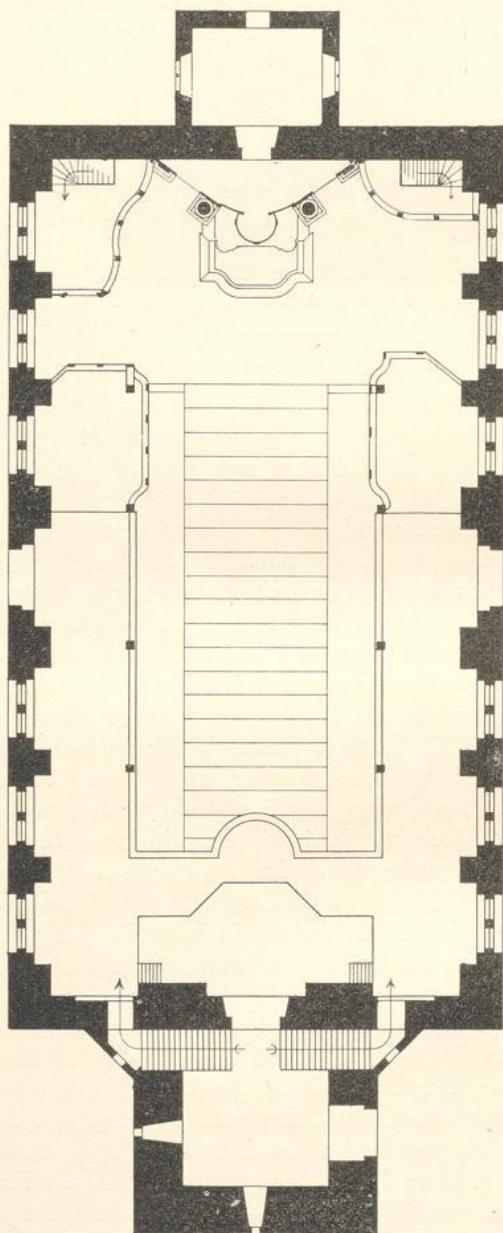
Kirche in Scheeßel; Grundriss.
